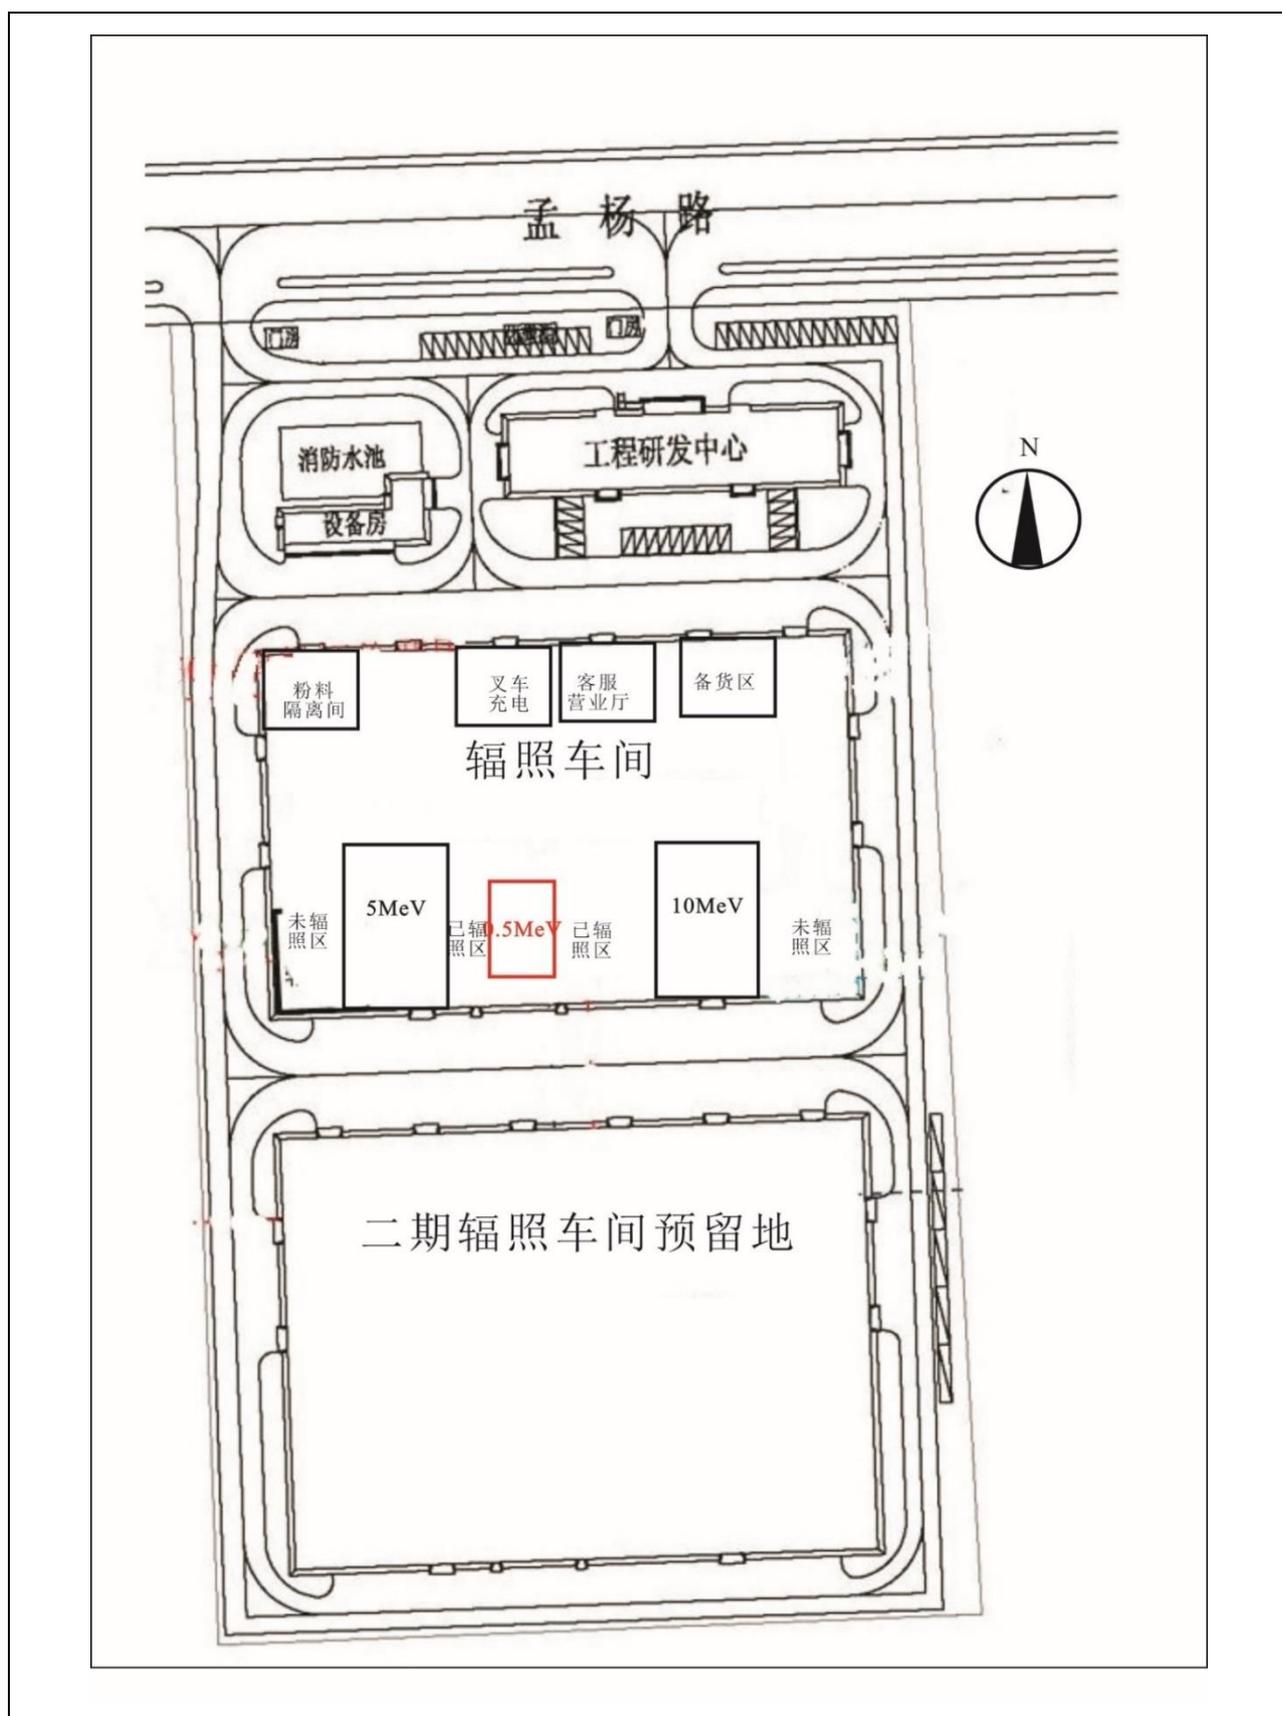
杨凌核盛辐照技术有限公司厂区总平面图
